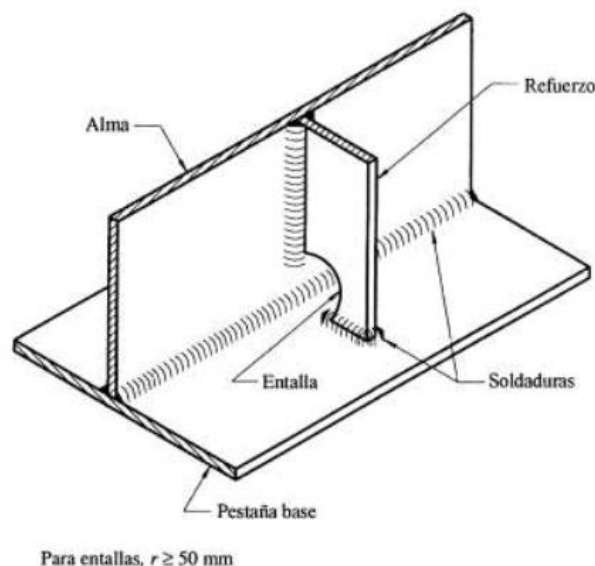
f Diseño recomendado de refuerzos para la protección frente a la corrosión
